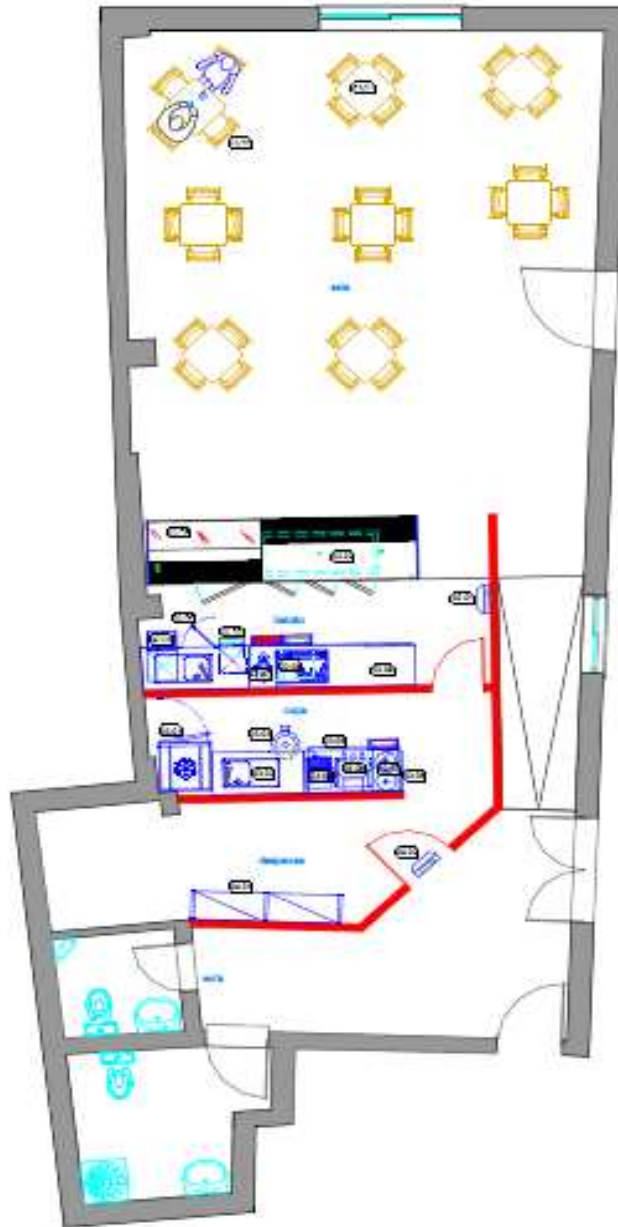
Adaptado da implantação do snack-bar (Ponto de Vista B)
